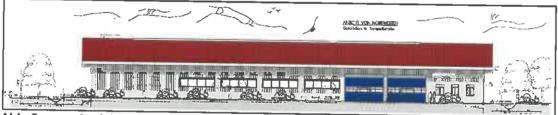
Ansicht von Nordwesten, Landbau Süd, Ingenieurbüro Fertigbau GmbH, Aalen vom 06.06./22.11.2018
